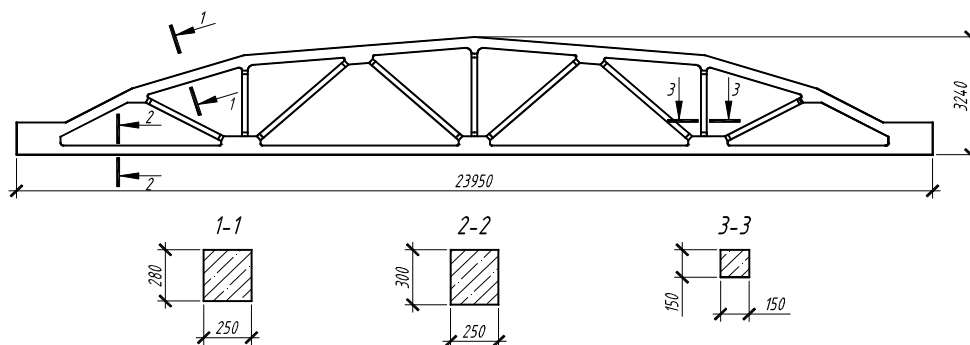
Ферма кроквяна залізобетонна сегментна 2ФС24-3К7
